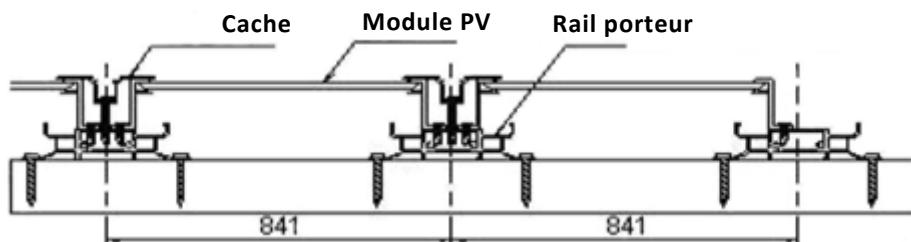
Vue en coupe des rails porteurs et des modules Just Roof
